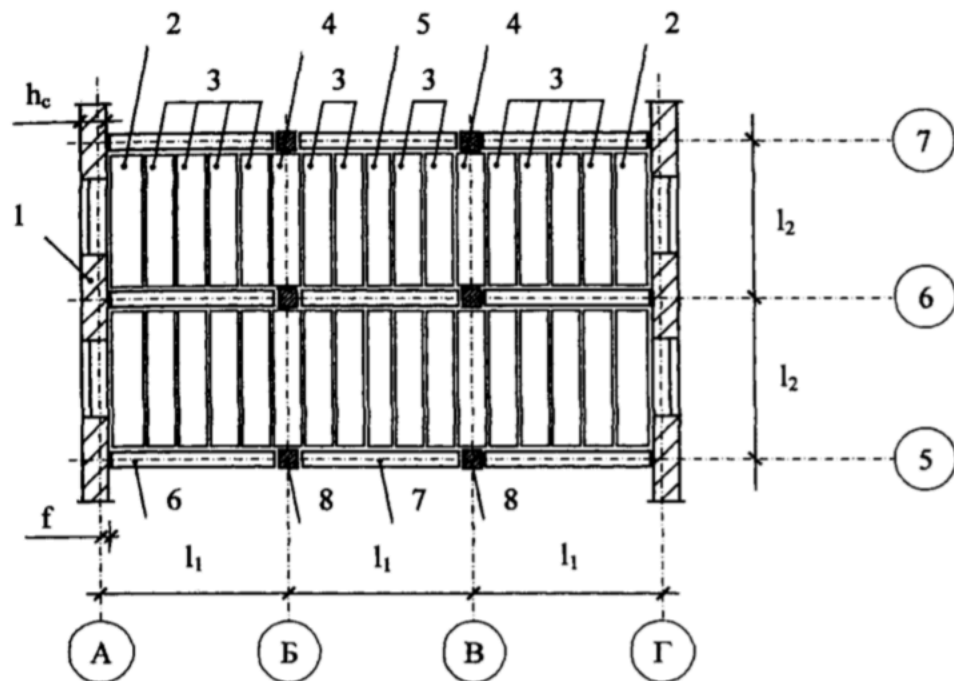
Монтажная схема (план) сборного железобетонного перекрытия здания с неполным несущим каркасом (панели опираются на ригели крестового сечения): 1 - наружная несущая кирпичная стена; 2 - доборная панель номинальной шириной 1,45 м; 3 - типовая панель номинальной шириной 1,3 м; 4 - распорная (связевая) панель по осям колонн номинальной шириной 1,3 м; 5 - доборная панель номинальной шириной 1,0 м; 6 - ригель, опирающийся на консоль колонны и на наружную стену; 7 - ригель, опирающийся на консоли колонн; 8 - сборная железобетонная колонна
